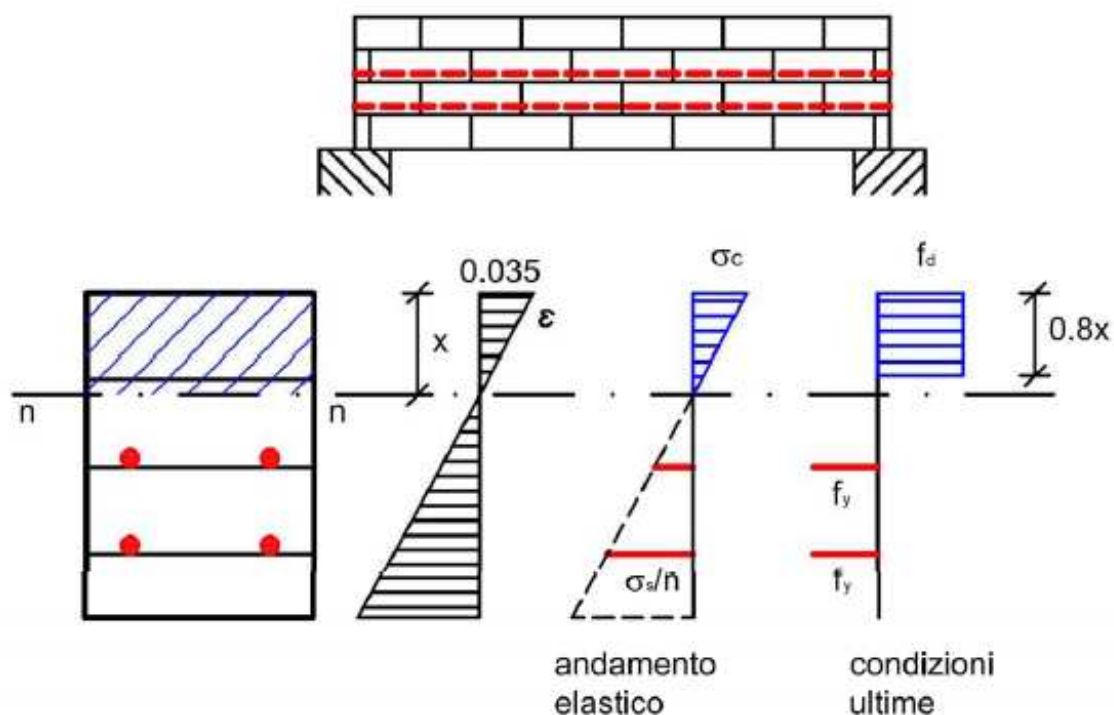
Stato di sollecitazione nella sezione di una muratura armata
